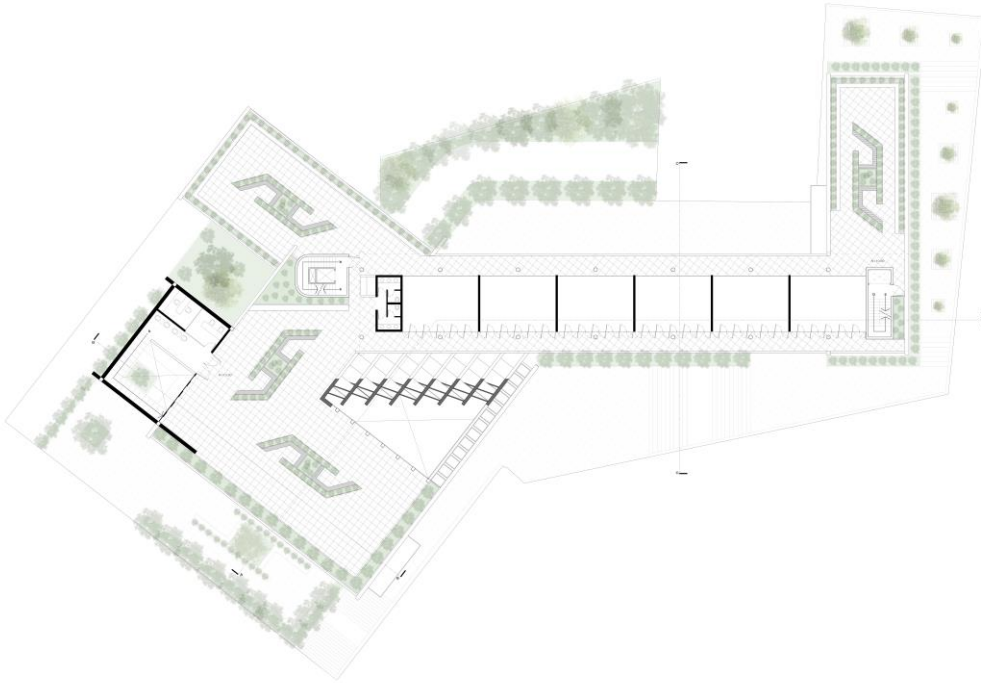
Planta baja nivel de ingreso – Nivel +/- 0.00. Por: Elaboración propia.
